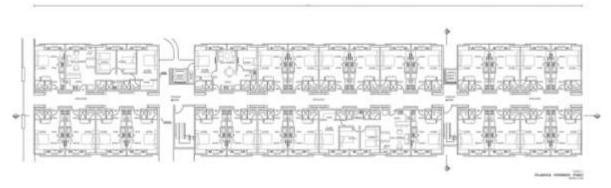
Planta arquitectónica torre 1 Frontera Living Apartments
